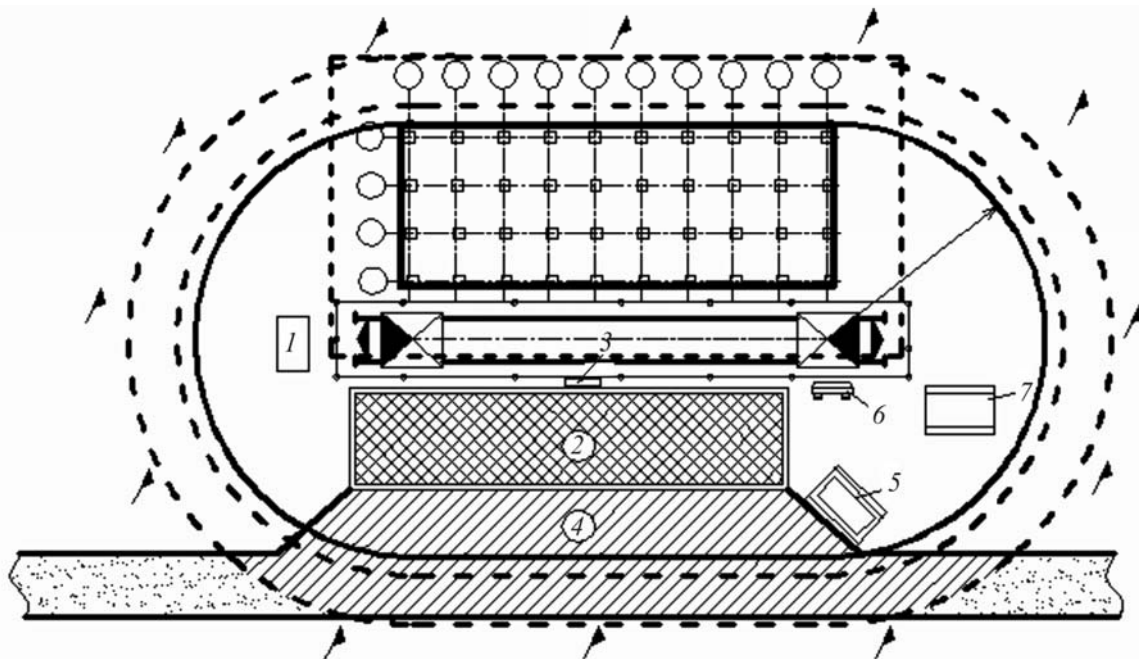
Схема размещения механизмов и инвентаря в опасной зоне работы крана с обозначением опасной зоны дороги (заштриховано): 1 — место нахождения контргруза; 2 — площадка для складирования; 3 — шкаф электропитания крана; 4 — площадка для разгрузки автотранспорта; 5 — площадка для приема раствора; 6 — стенд со схемами строповки грузов; 7 — место для хранения грузозахватных приспособлений и тары
